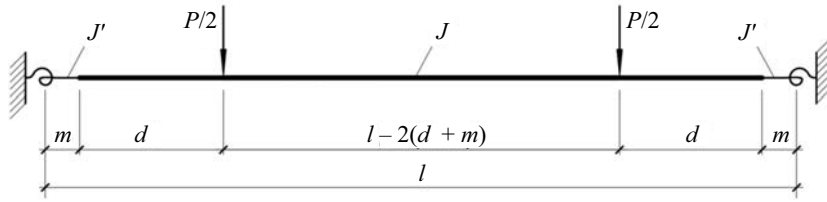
Расчетная схема балки ступенчатой жесткости, упруго защемленной на опорах
